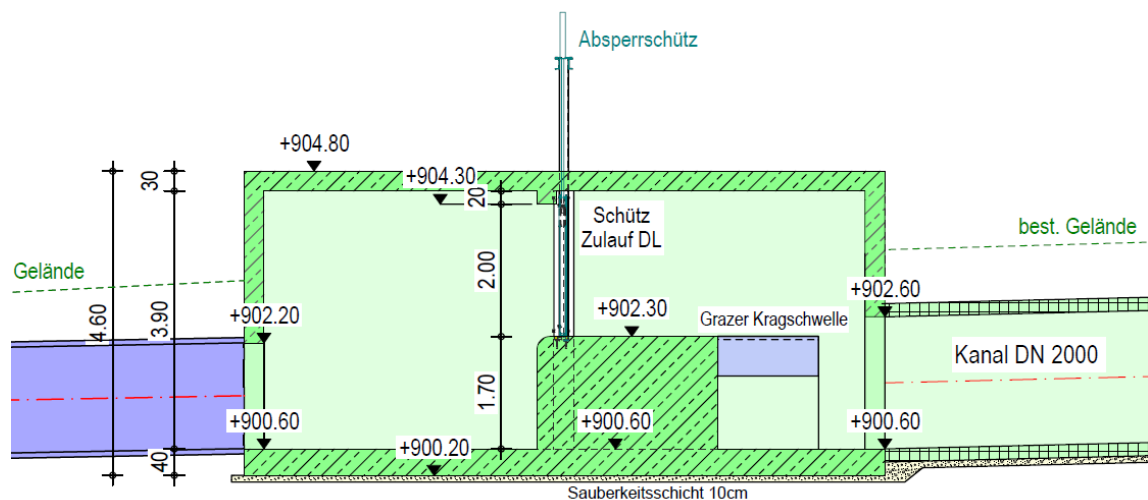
Schnitt Auslaufbauwerk Sandfang und Zulauf zur Druckrohrleitung
